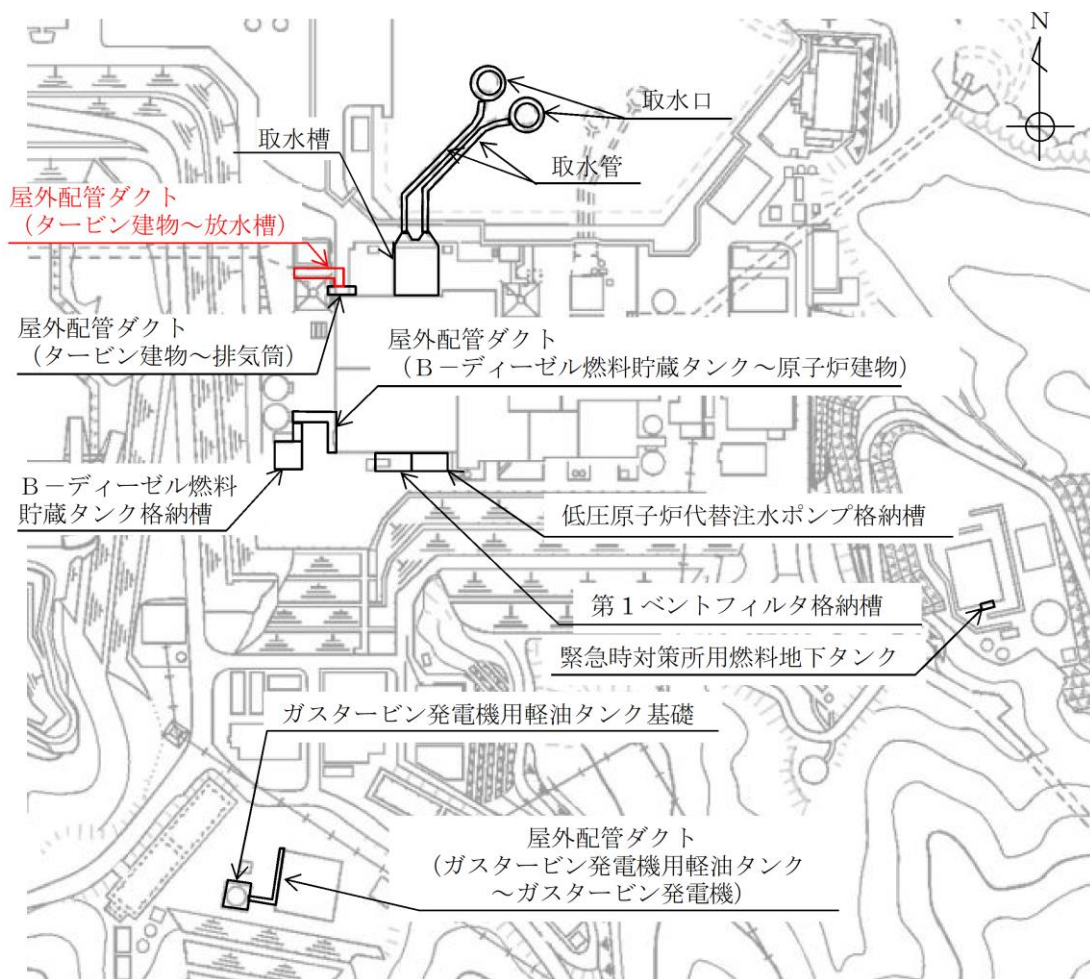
屋外配管ダクト（タービン建物～放水槽） 配置図
